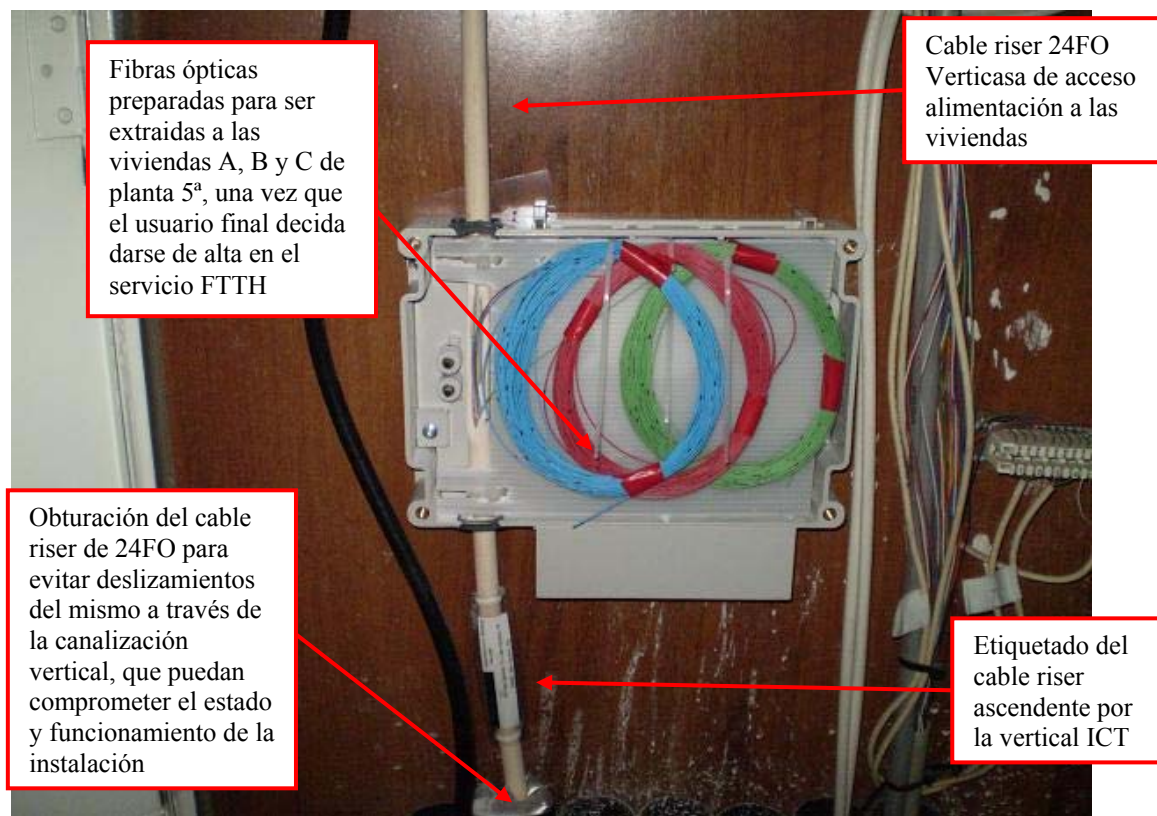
Vista exterior de caja Riser Box Verticasa, de derivación de planta 8ª
